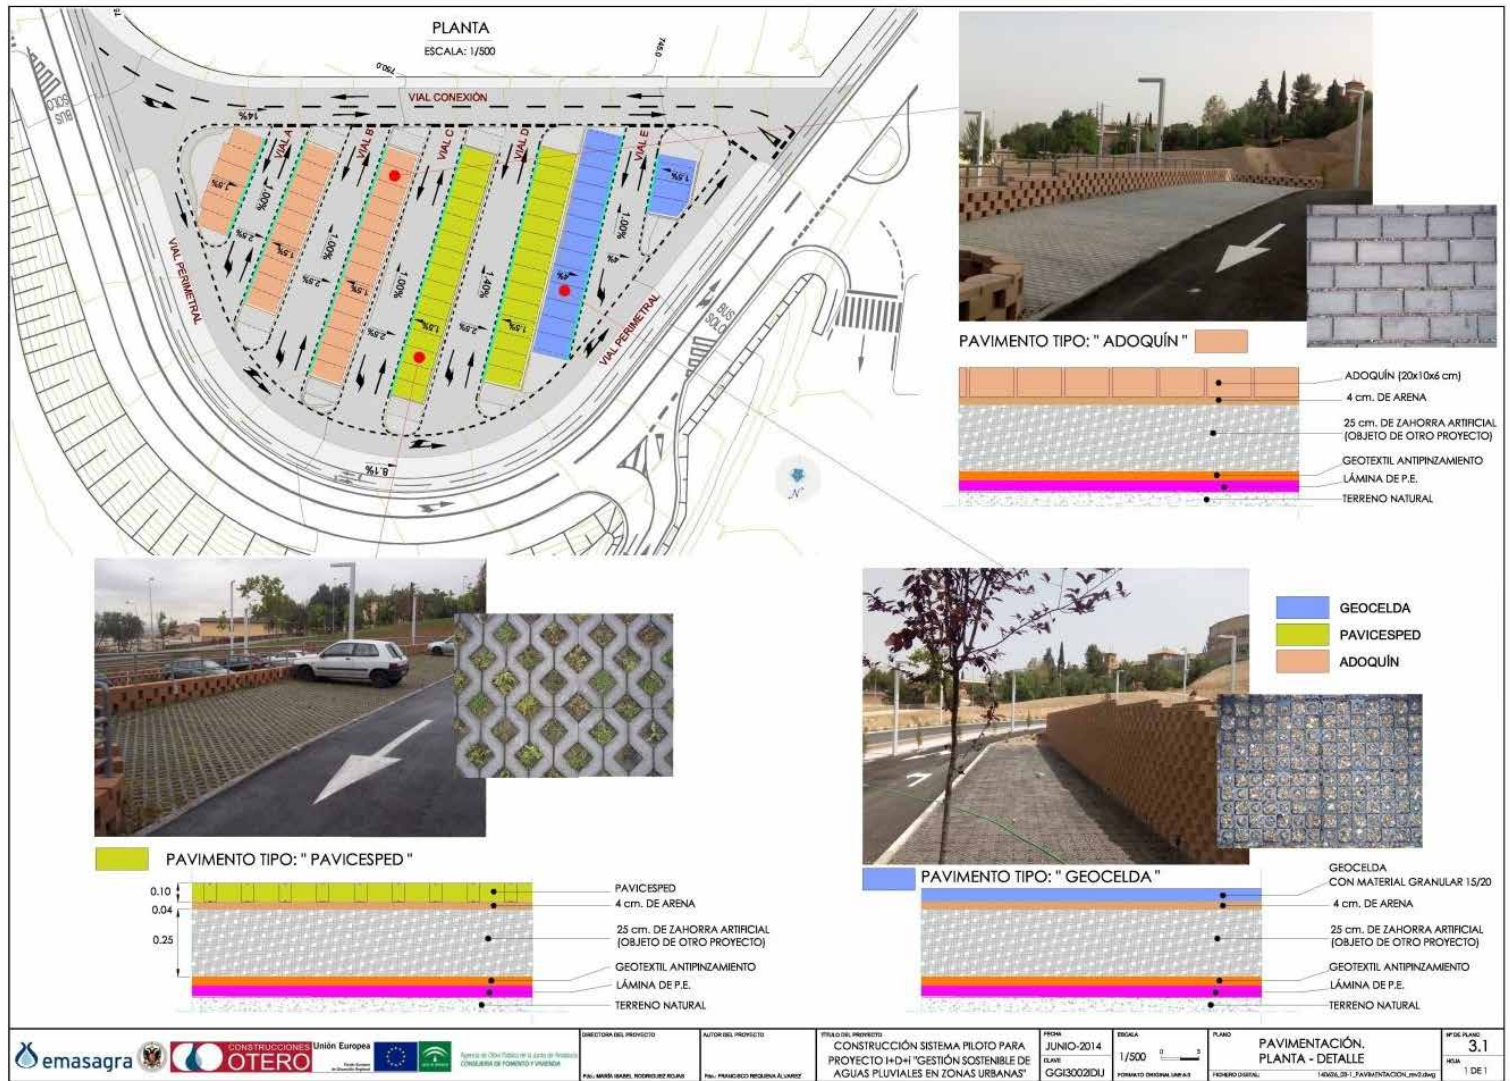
Tipologías de pavimentos ensayados y secciones constructivas
